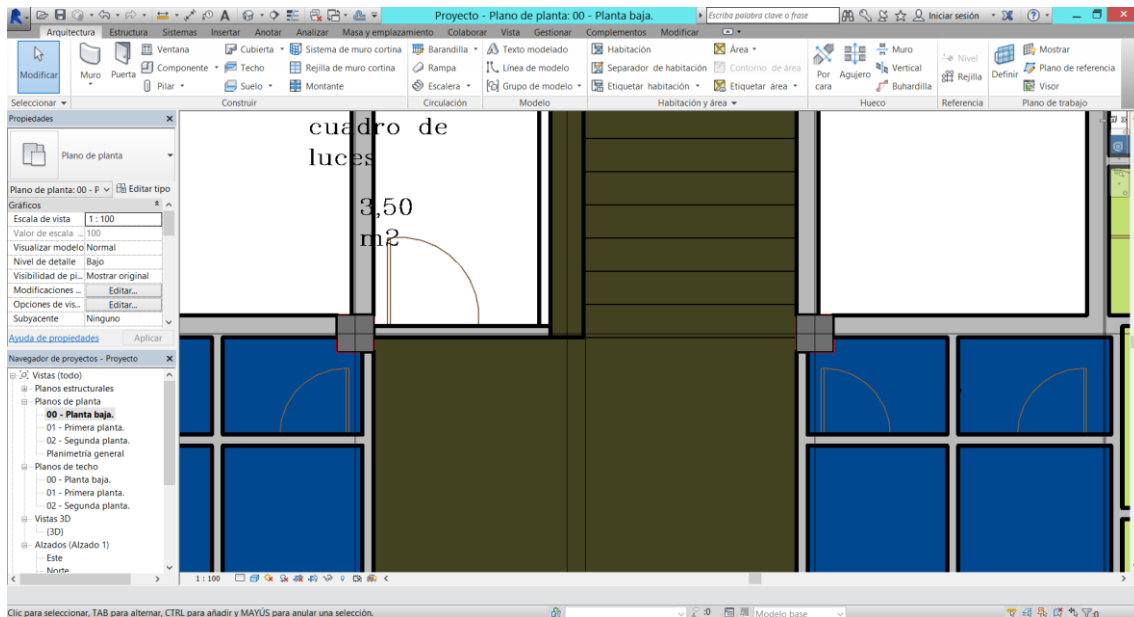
Vista en planta Pilar rectangular hormigón 330 x 330 mm. Fuente: Elaboración propia.
